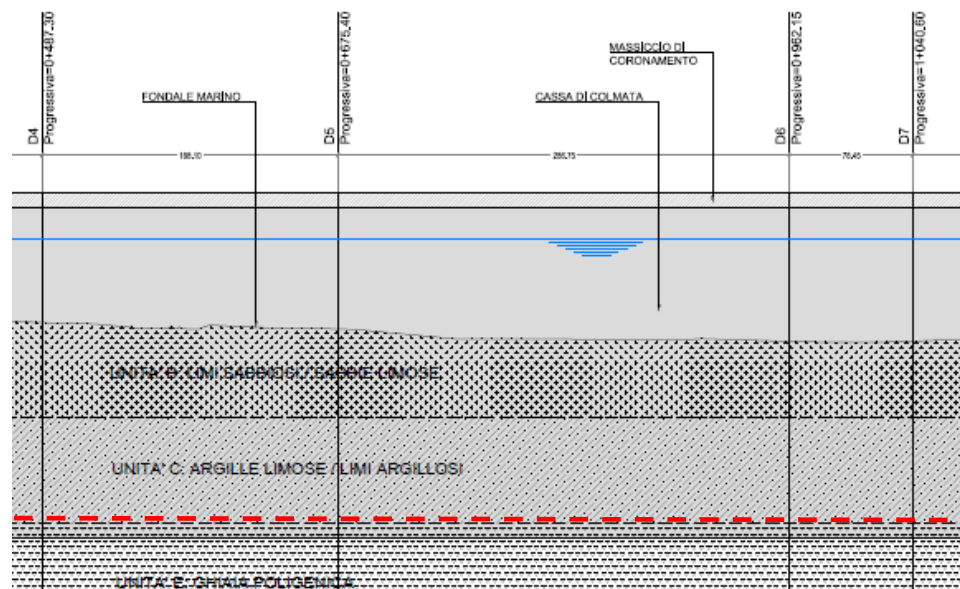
k: Diga Foranea - Prospetto Diaframma Plastico
